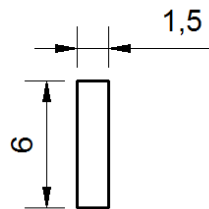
Penampang melintang girder 1 dalam cm.
